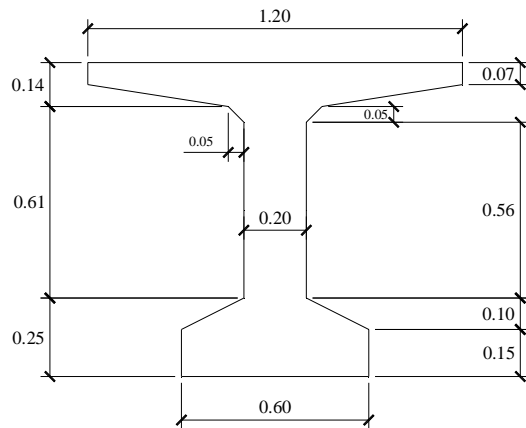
Dimensiones de Vigas de HoPo
